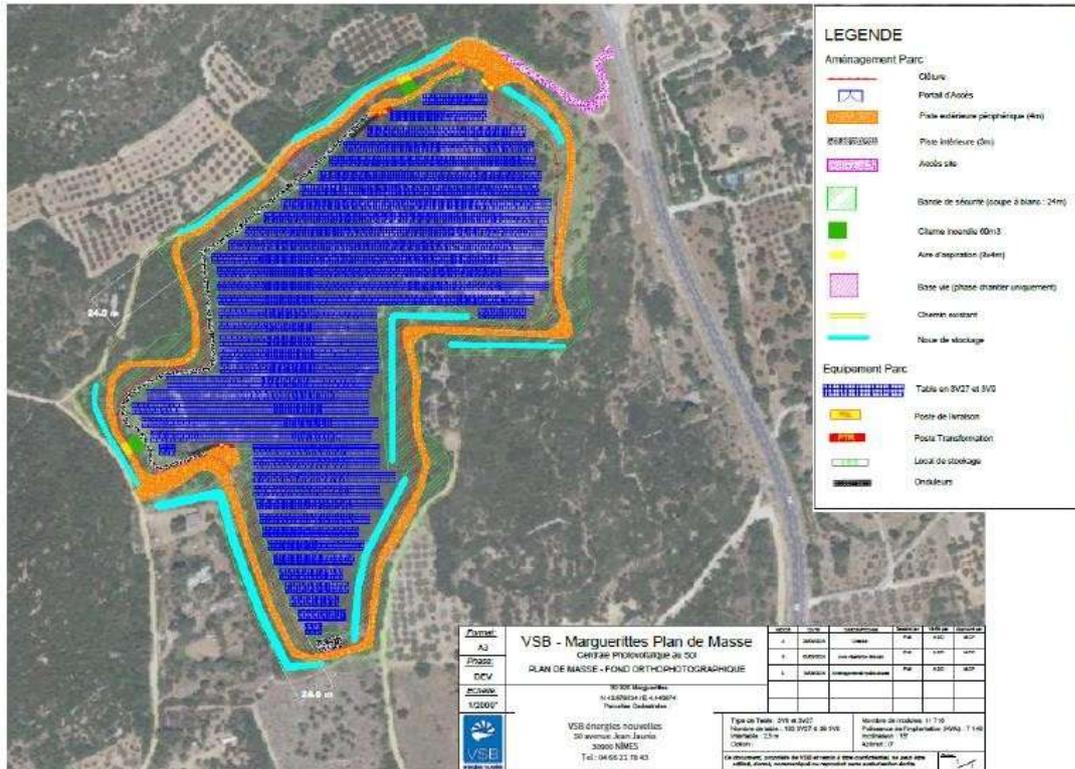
Plan d'implantation de la centrale photovoltaïque
